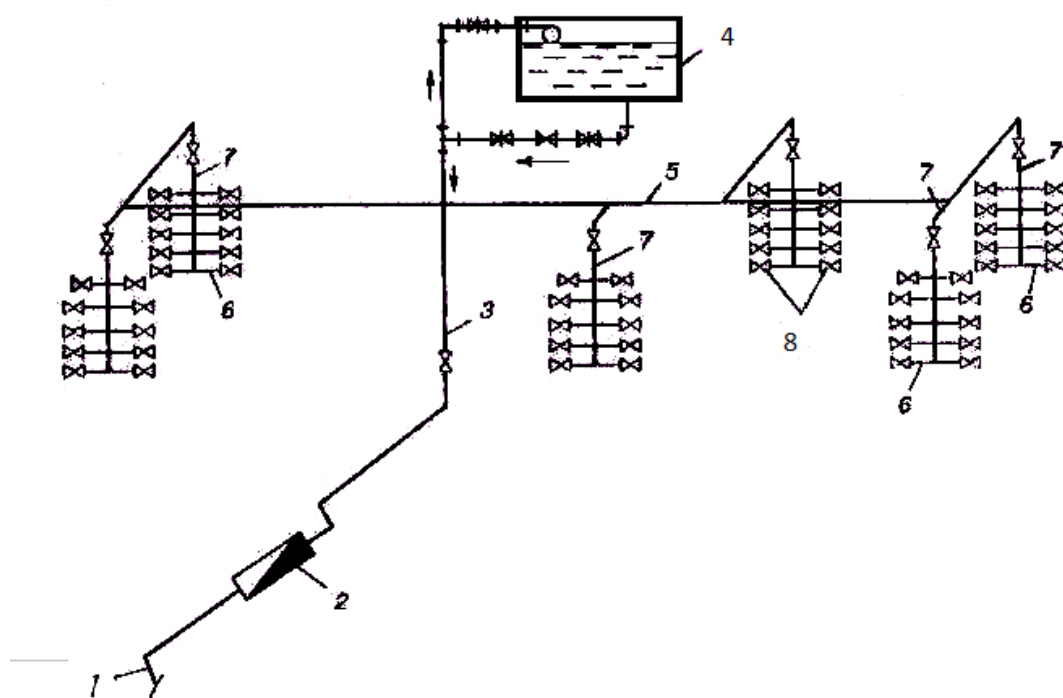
Система водоснабжения здания с водонапорным баком. 1 – ввод; 2 – водомерный узел; 3 – подающий стояк; 4 – водонапорный бак; 5 – разводящий трубопровод; 6 – подводки трубопровода в номера; 7 – стояки; 8 – вентили
